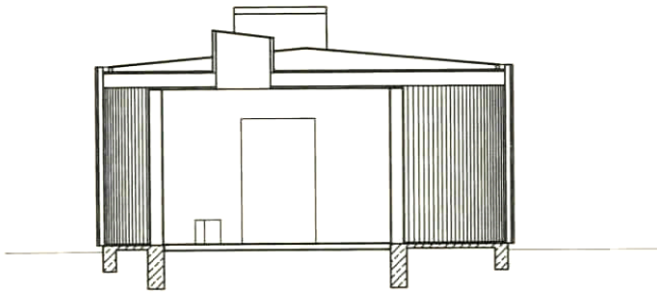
Sección Capilla de la Reconciliación. Estructura de muros en tapial y pilares de madera recibiendo una cubierta ligera de madera con dos lucernarios.
